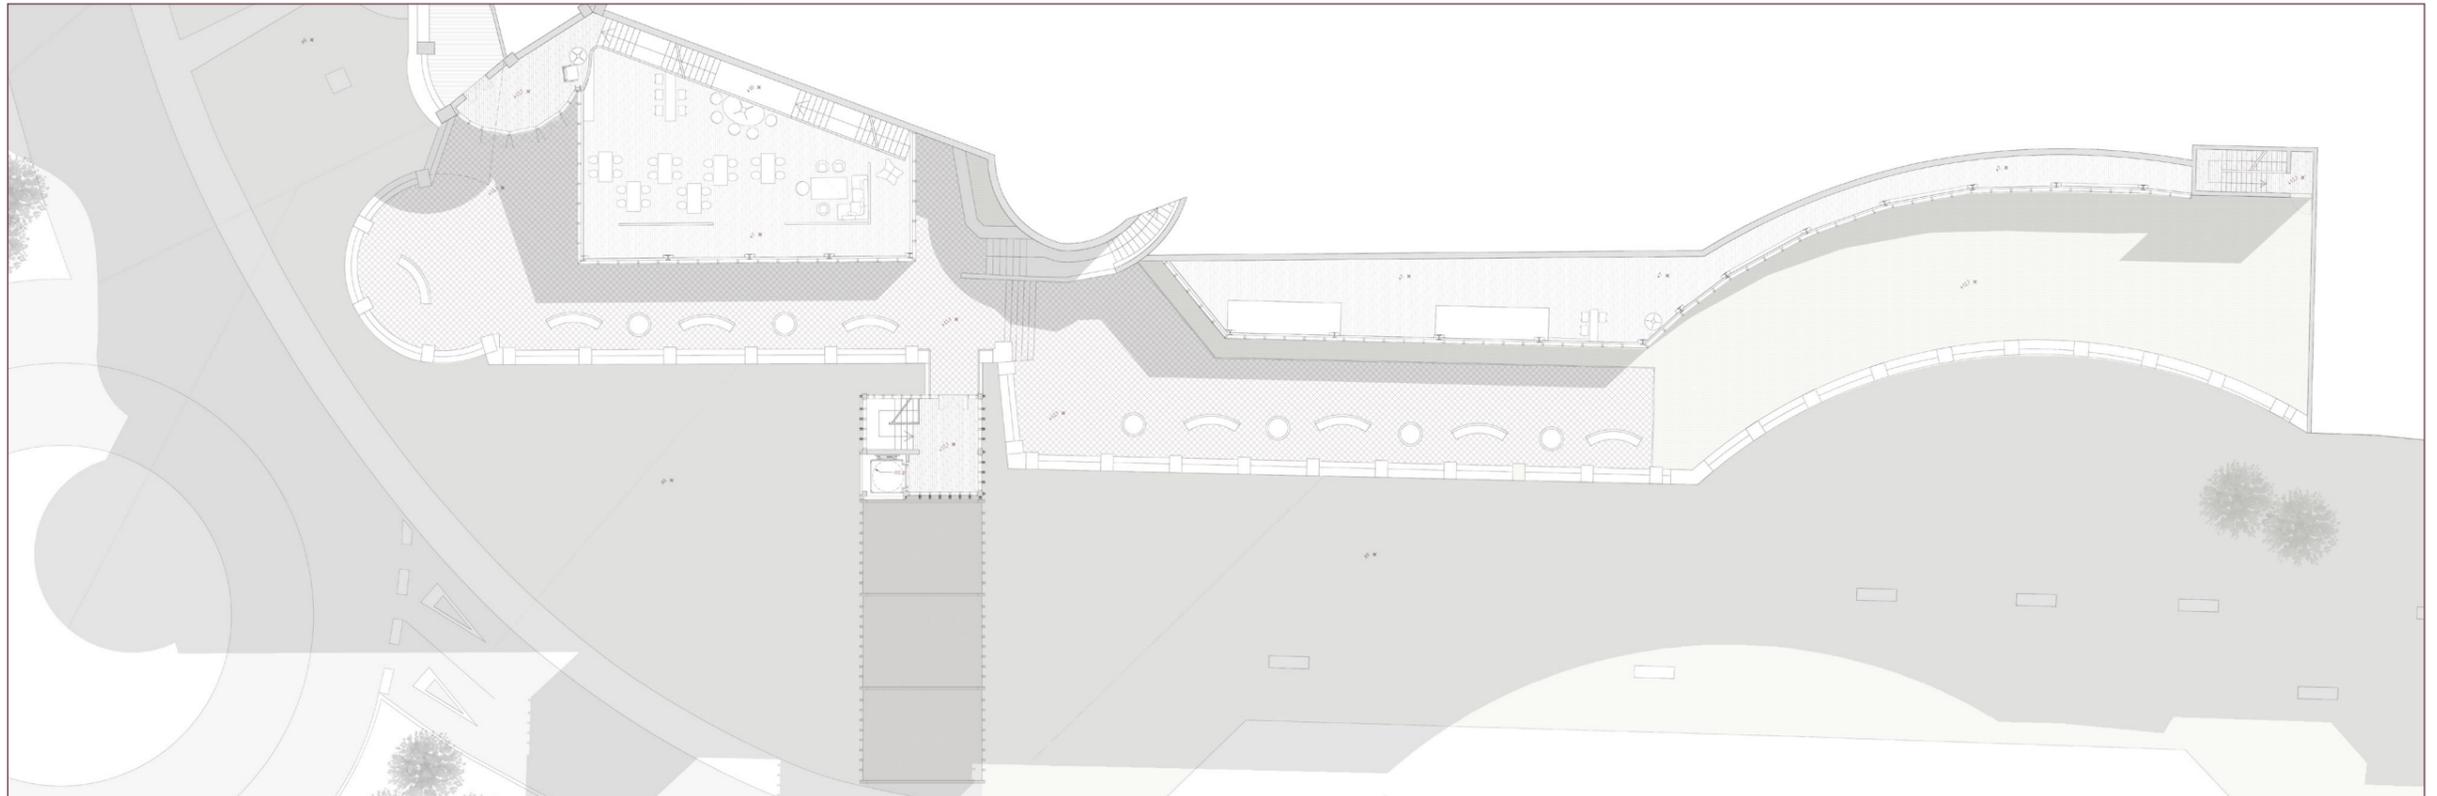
Planta de las terrazas sobre la galería suroeste, conexión entre el espacio coworking y la galería noroeste.
